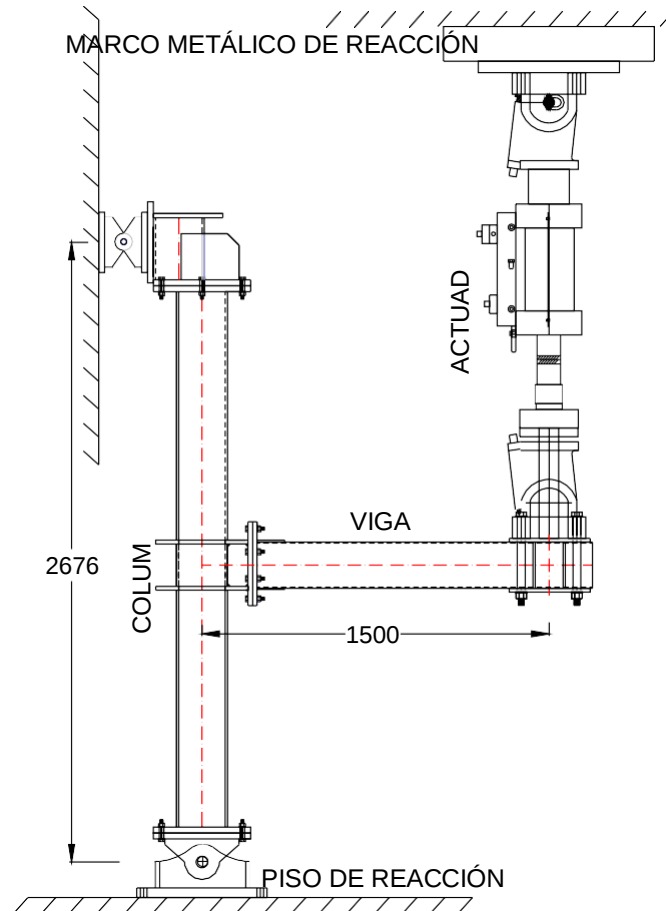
Vista lateral del ensamble para el ensayo, dimensiones en milímetros
